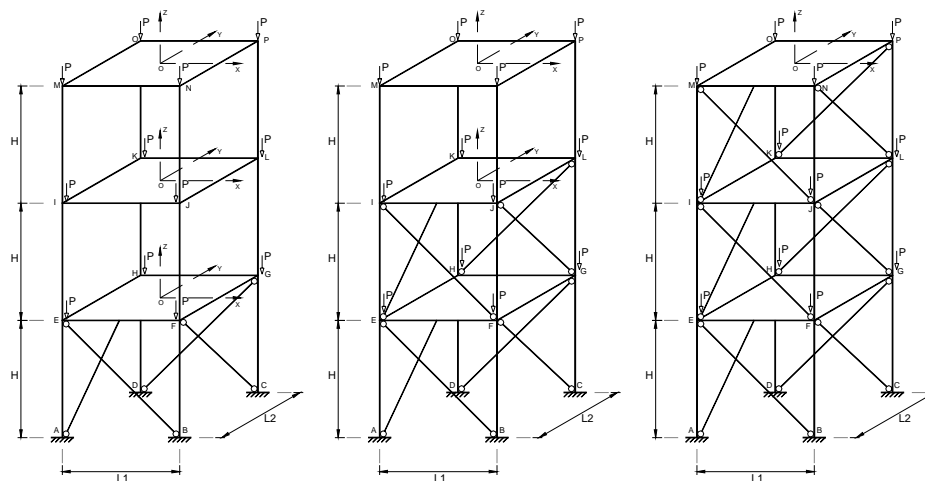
Pórtico 3D contraventado em altura (pisos: 1; 1-2; 1-2-3) em 4 planos
